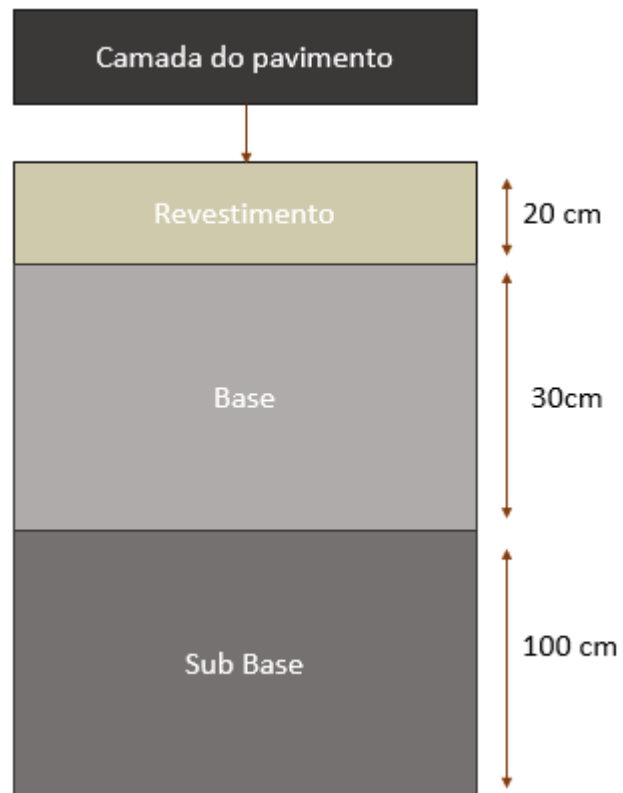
Dimensionamento da camada do pavimento plano horizontal
